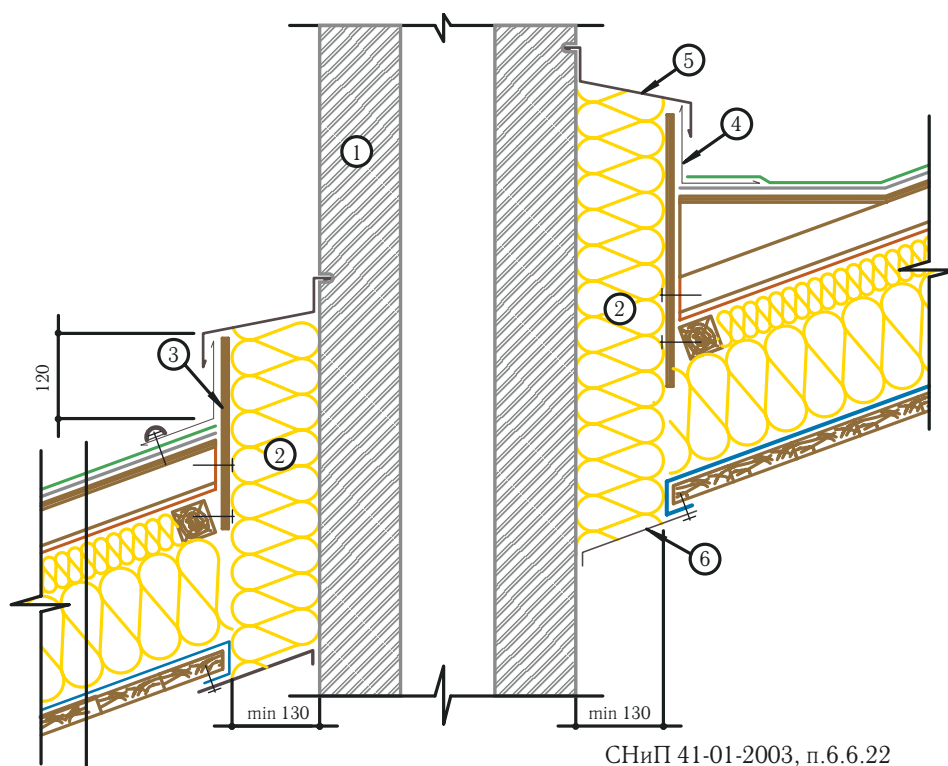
Примыкание кровли «жилой мансарды» к вентиляционной трубе
